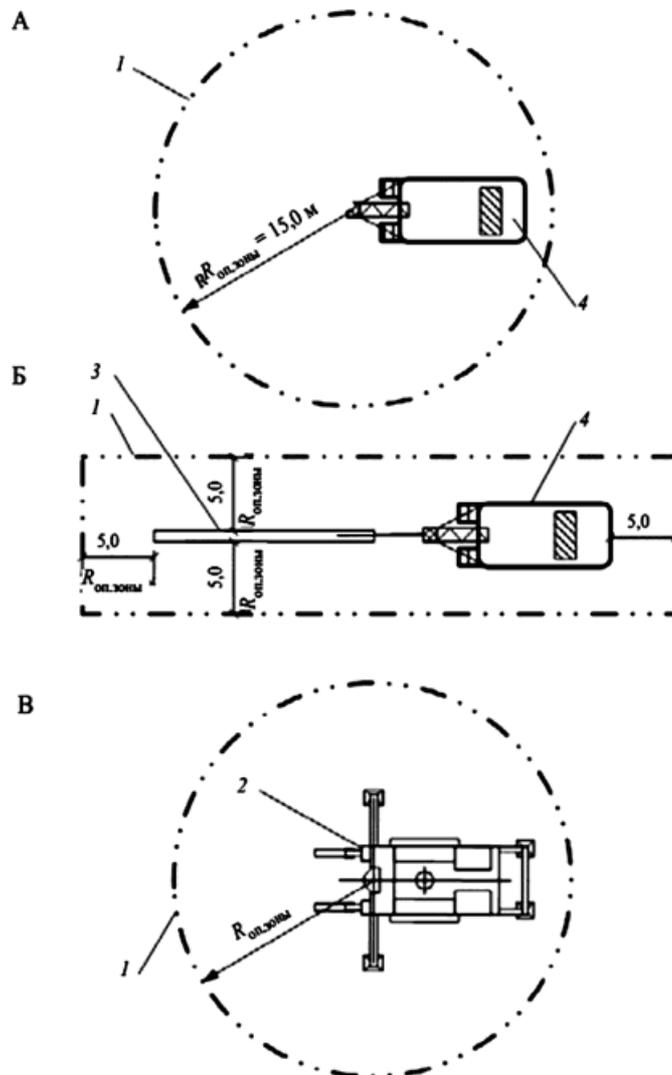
Расчётная схема определения опасных зон при устройстве свай:
